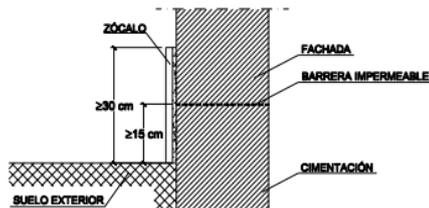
Ejemplo de arranque de la fachada desde la cimentación
